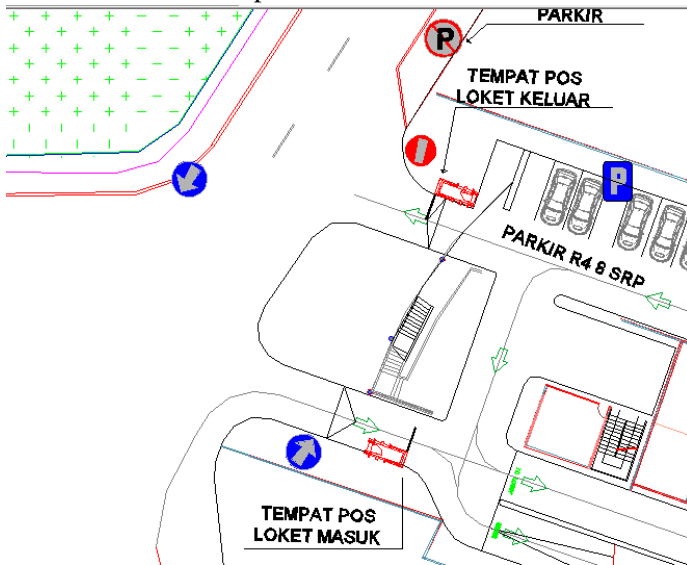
Layout Ruang Parkir Pada Lantai Basement 2 Hotel Amaris
